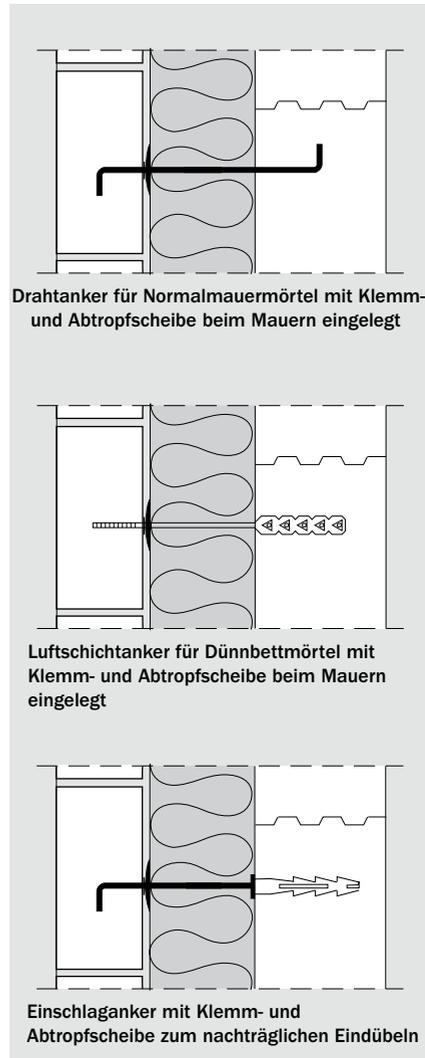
/43: Luftschichtanker für zweischaliges Mauerwerk (Draufsicht)
